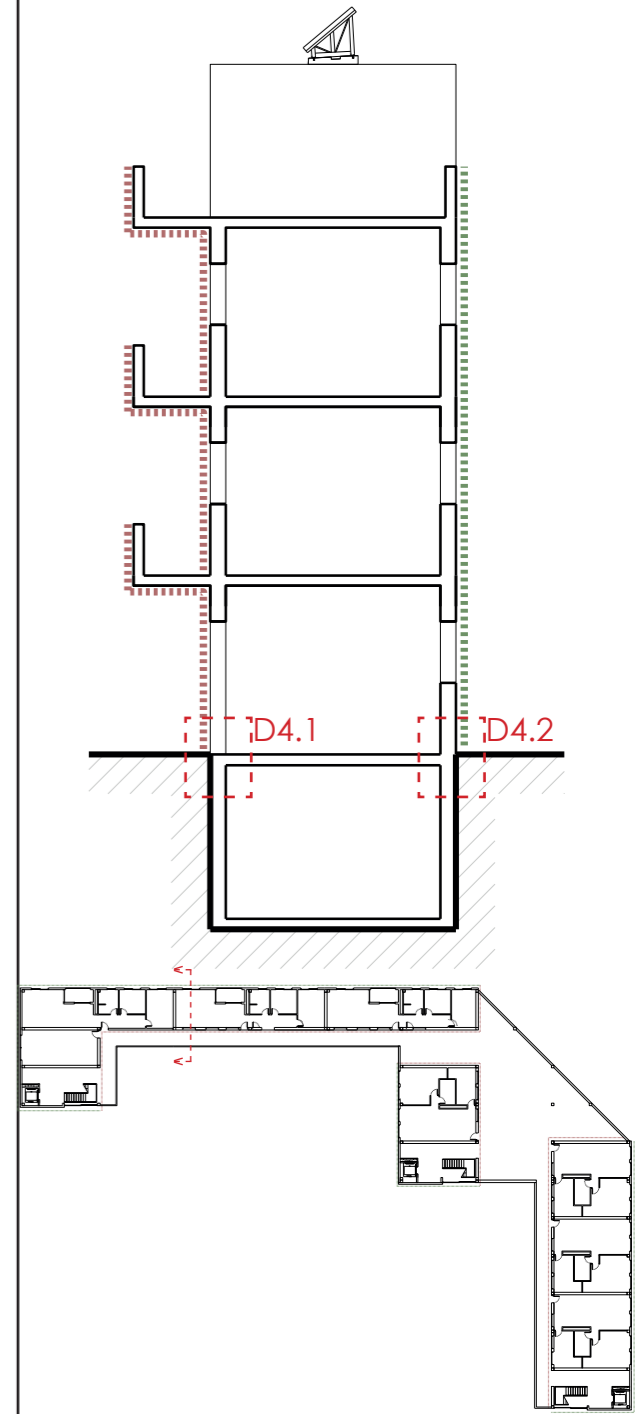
Ejemplo de arranque de la fachada desde la cimentación
